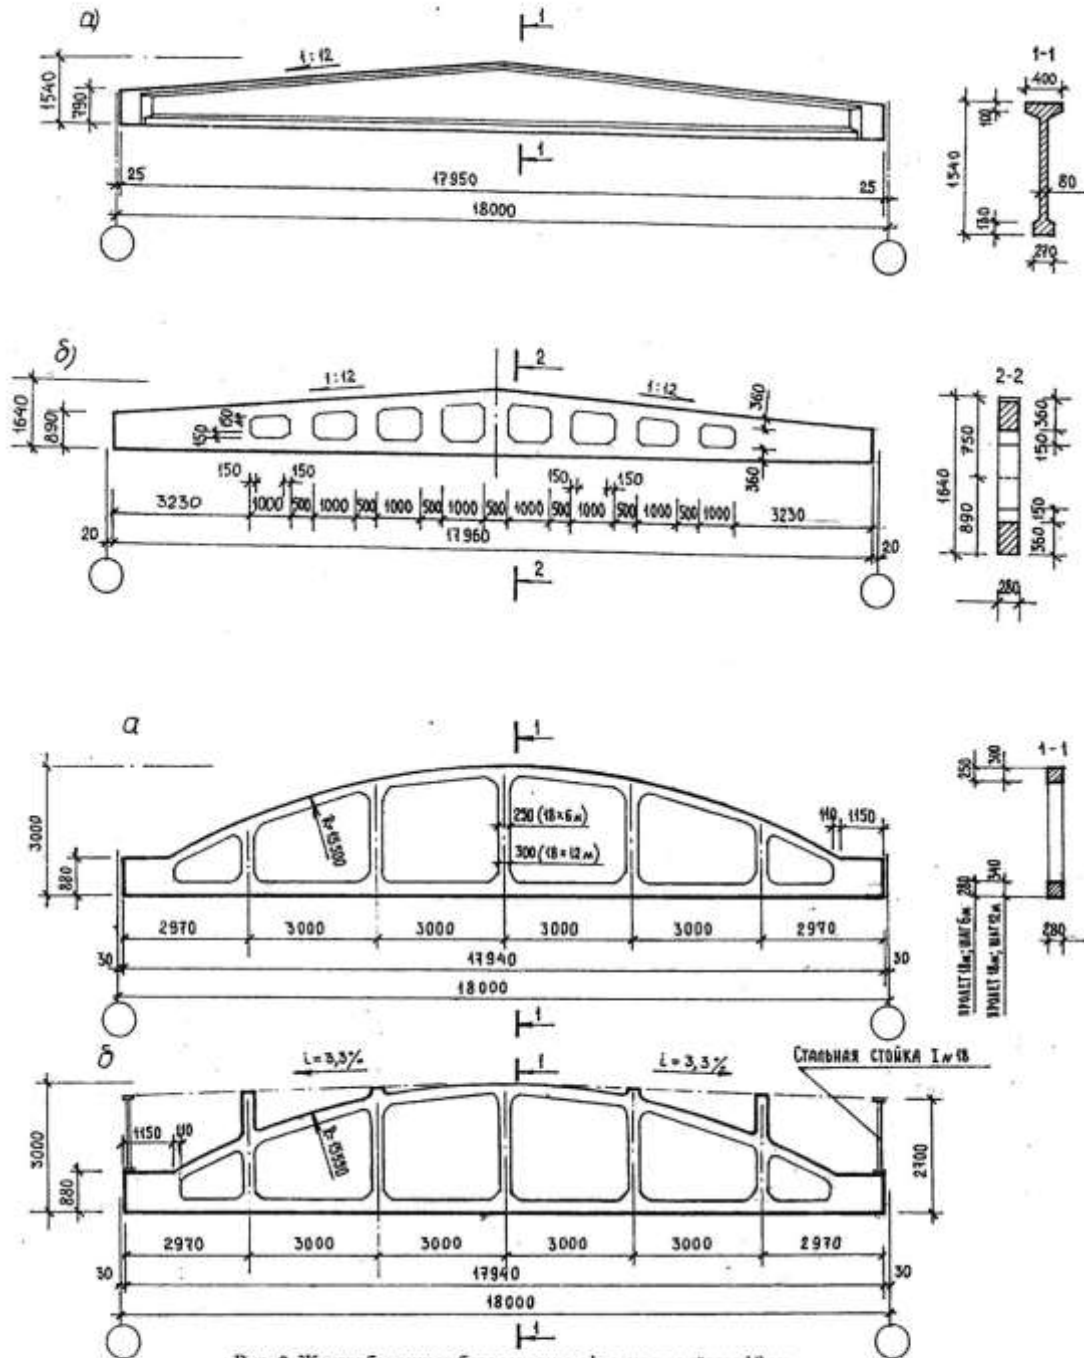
Железобетонные безраскосные фермы пролётом 18 м:
